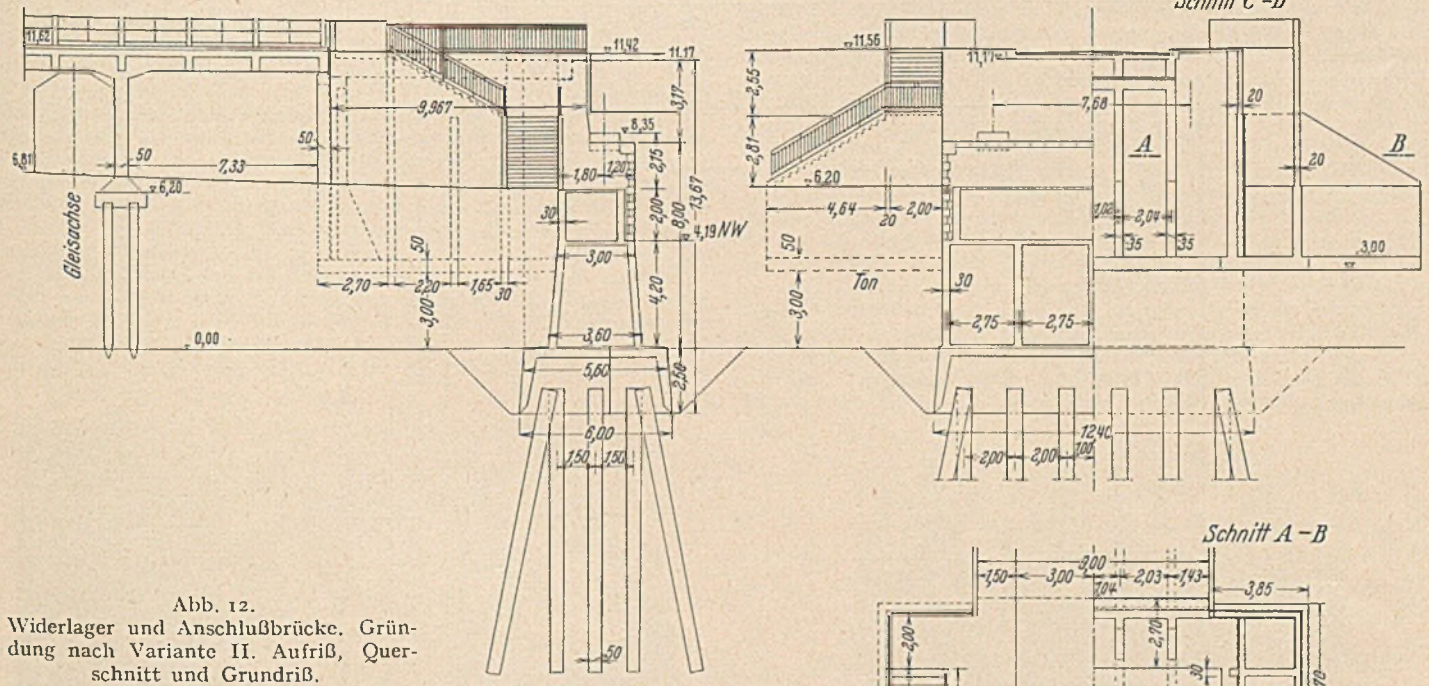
Widerlager und Anschlußbrücke. Gründung nach Variante II. Aufriß, Querschnitt und Grundriß.
